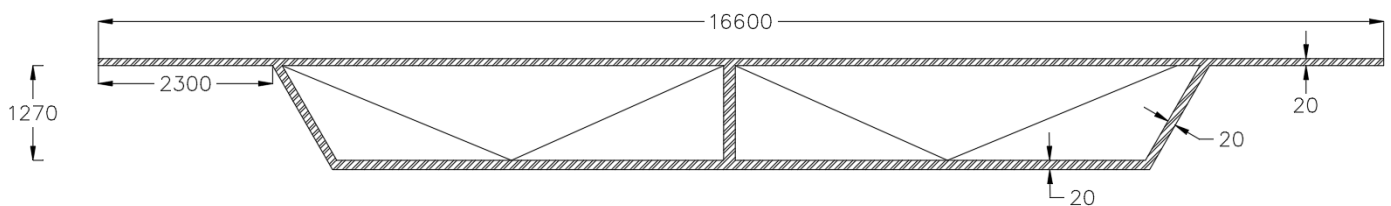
Geometría tablero viga ortótropa
